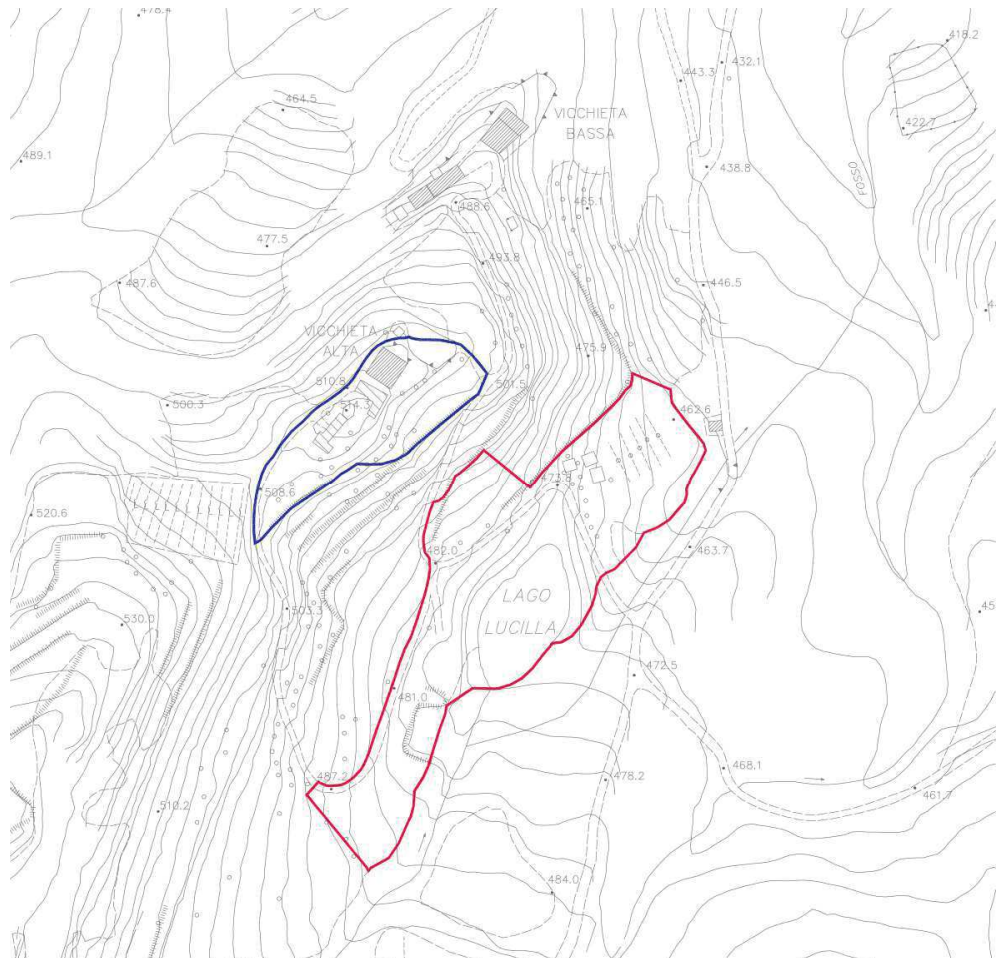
Perimetro in rosso dell’area di intervento e in bleu l’area di recupero di Vicchieta
